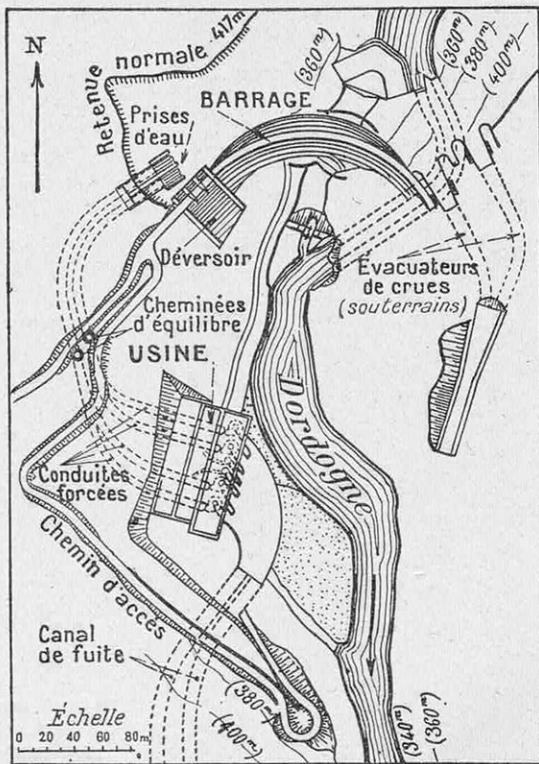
PLAN GÉNÉRAL DU BARRAGE ET DE L'USINE HYDROÉLECTRIQUE DE MARÈGES, INSTALLÉS SUR LA HAUTE-DORDOGNE
